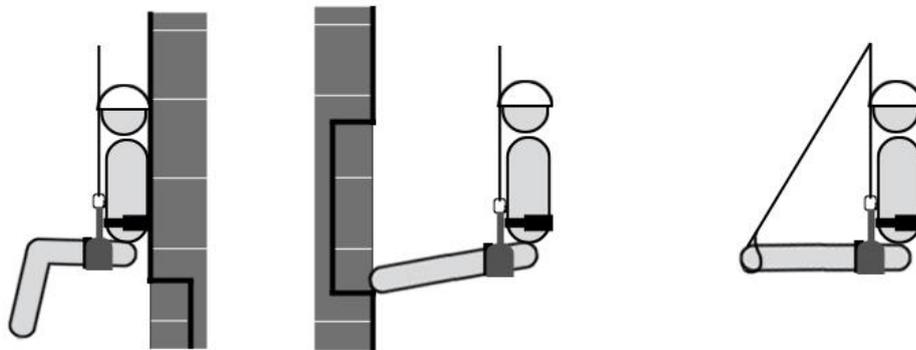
Izquierda: apoyo de la espalda en la fachada vertical. Derecha: apoyo de las piernas en la repisa o mediante el estribo.
